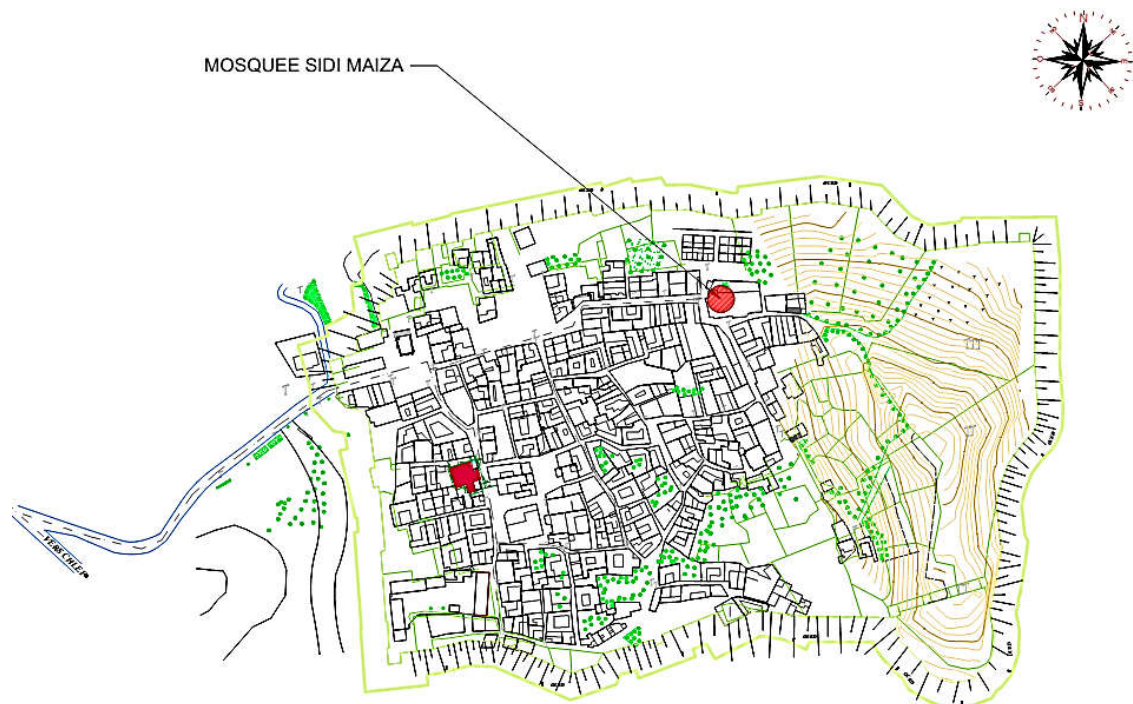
Plan de situation de la mosquée Sidi Maiza.
